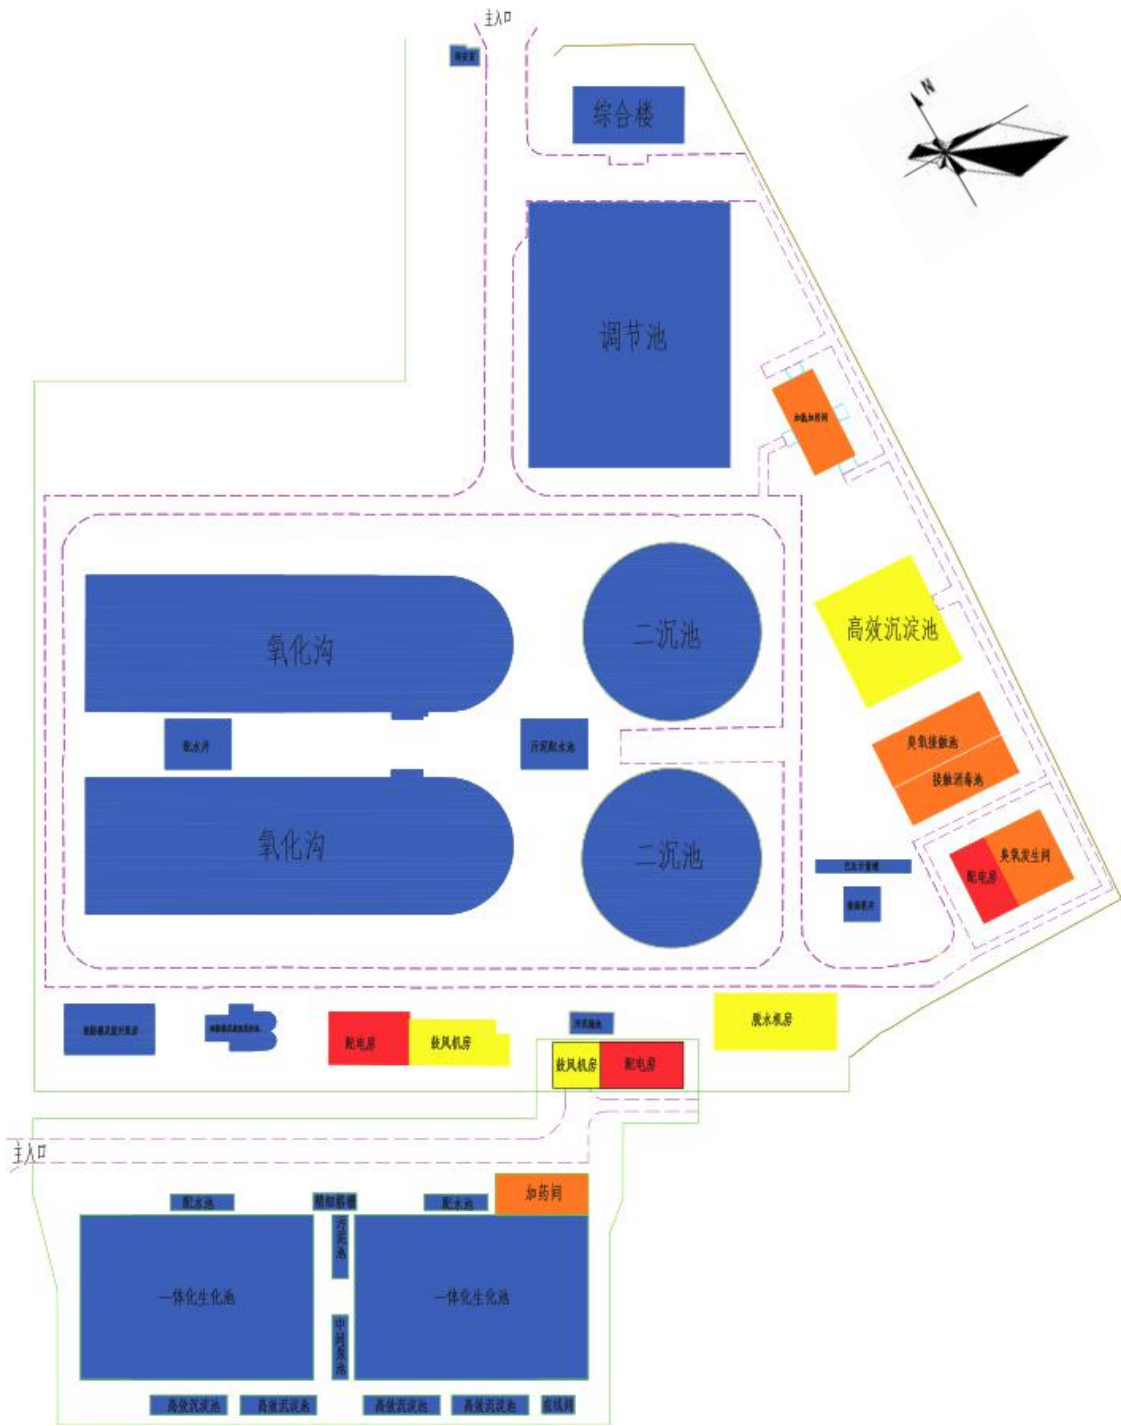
角美城市污水处理厂现有工程平面布置图
